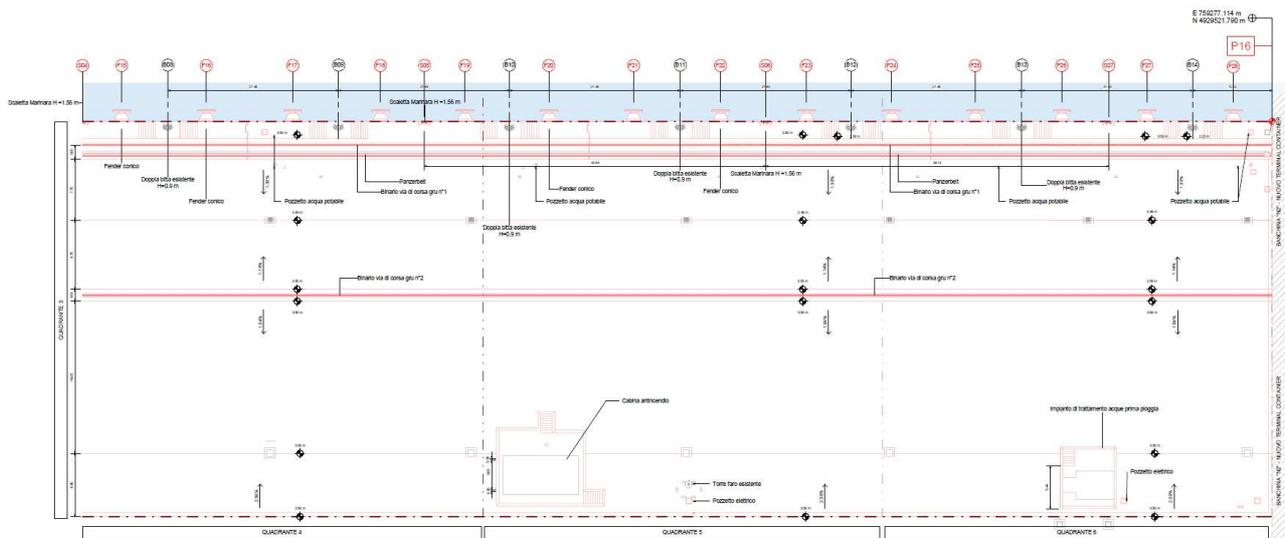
N1 – Planimetria di progetto / Quadranti 4-5-6.
